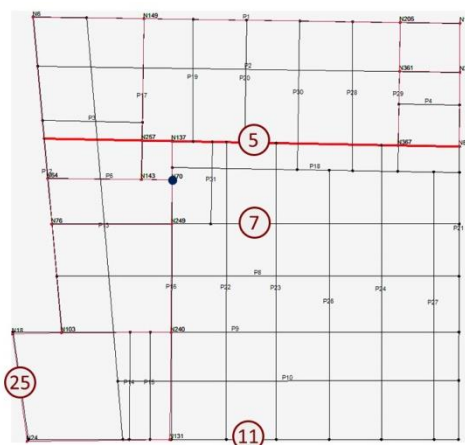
posizionamento delle pareti in pianta e del nodo di controllo.
